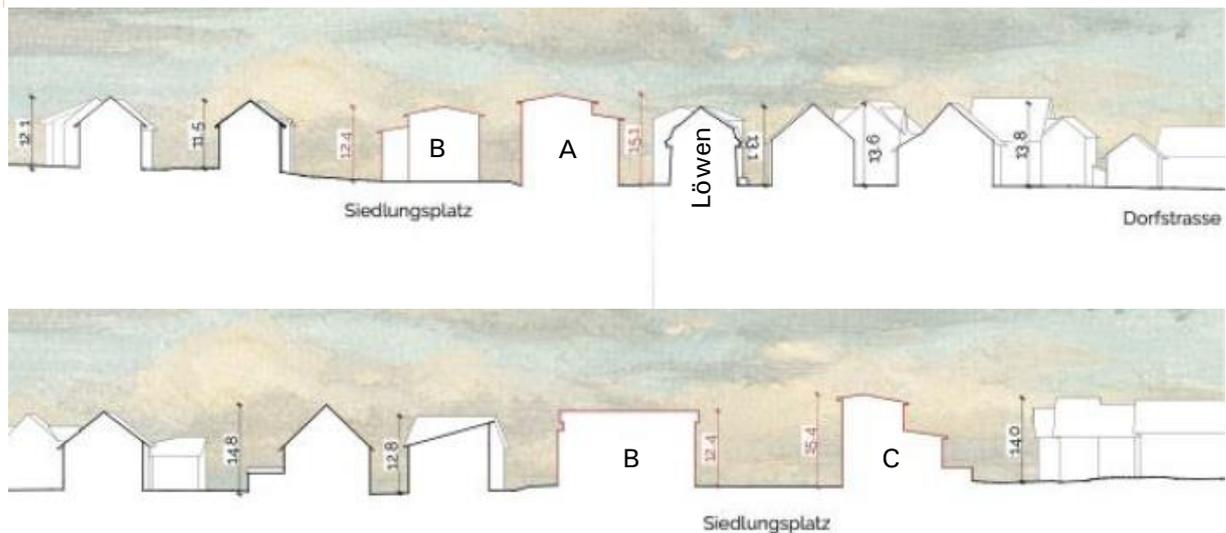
Höhenentwicklung (Quelle: Erläuterungsbericht zum Gestaltungsplan, mit ergänzten Gebäudebezeichnungen)
